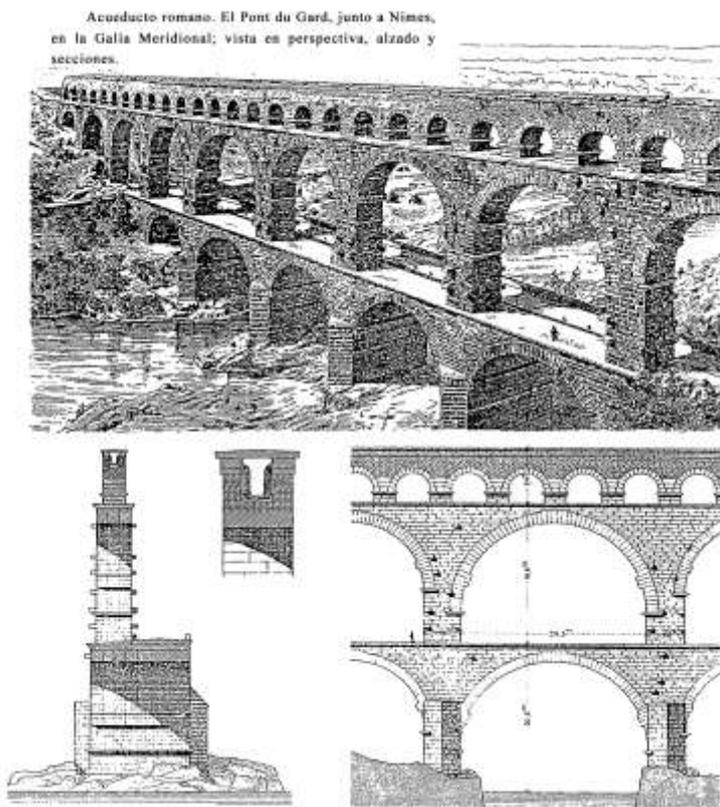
El Pont du Gard; vista en perspectiva, alzado y secciones.
